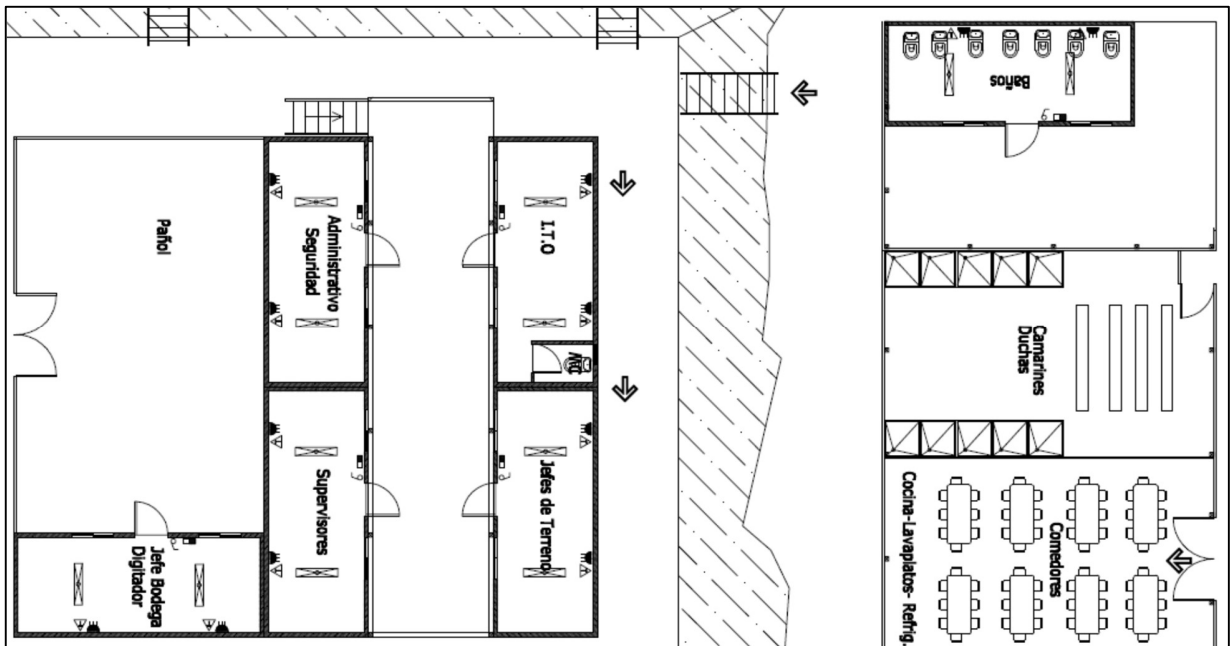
DETALLE INSTALACIÓN DE FAENA PRIMER PISO
